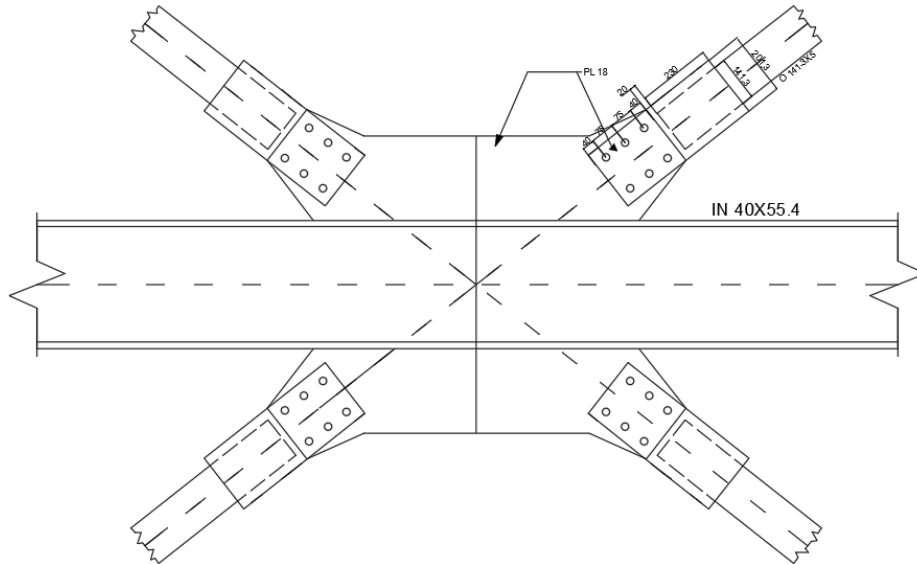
Detalle disposición X perfil O 141.3x5 conexión con viga.
